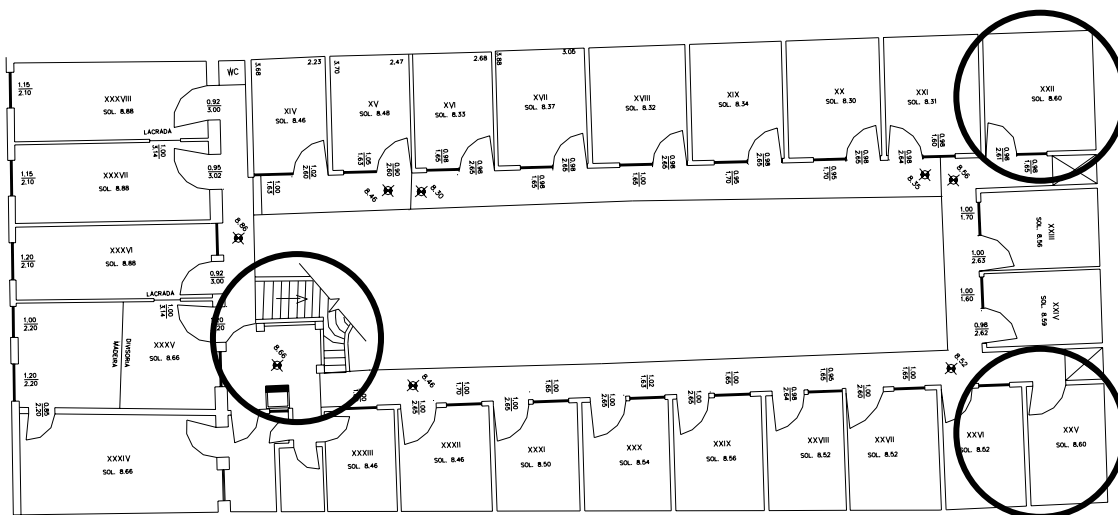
Planta baixa do segundo pavimento, antes da intervenção. Em destaque a escada e os cômodos existentes na parte posterior da edificação (SDL, 1995, p. 1).
